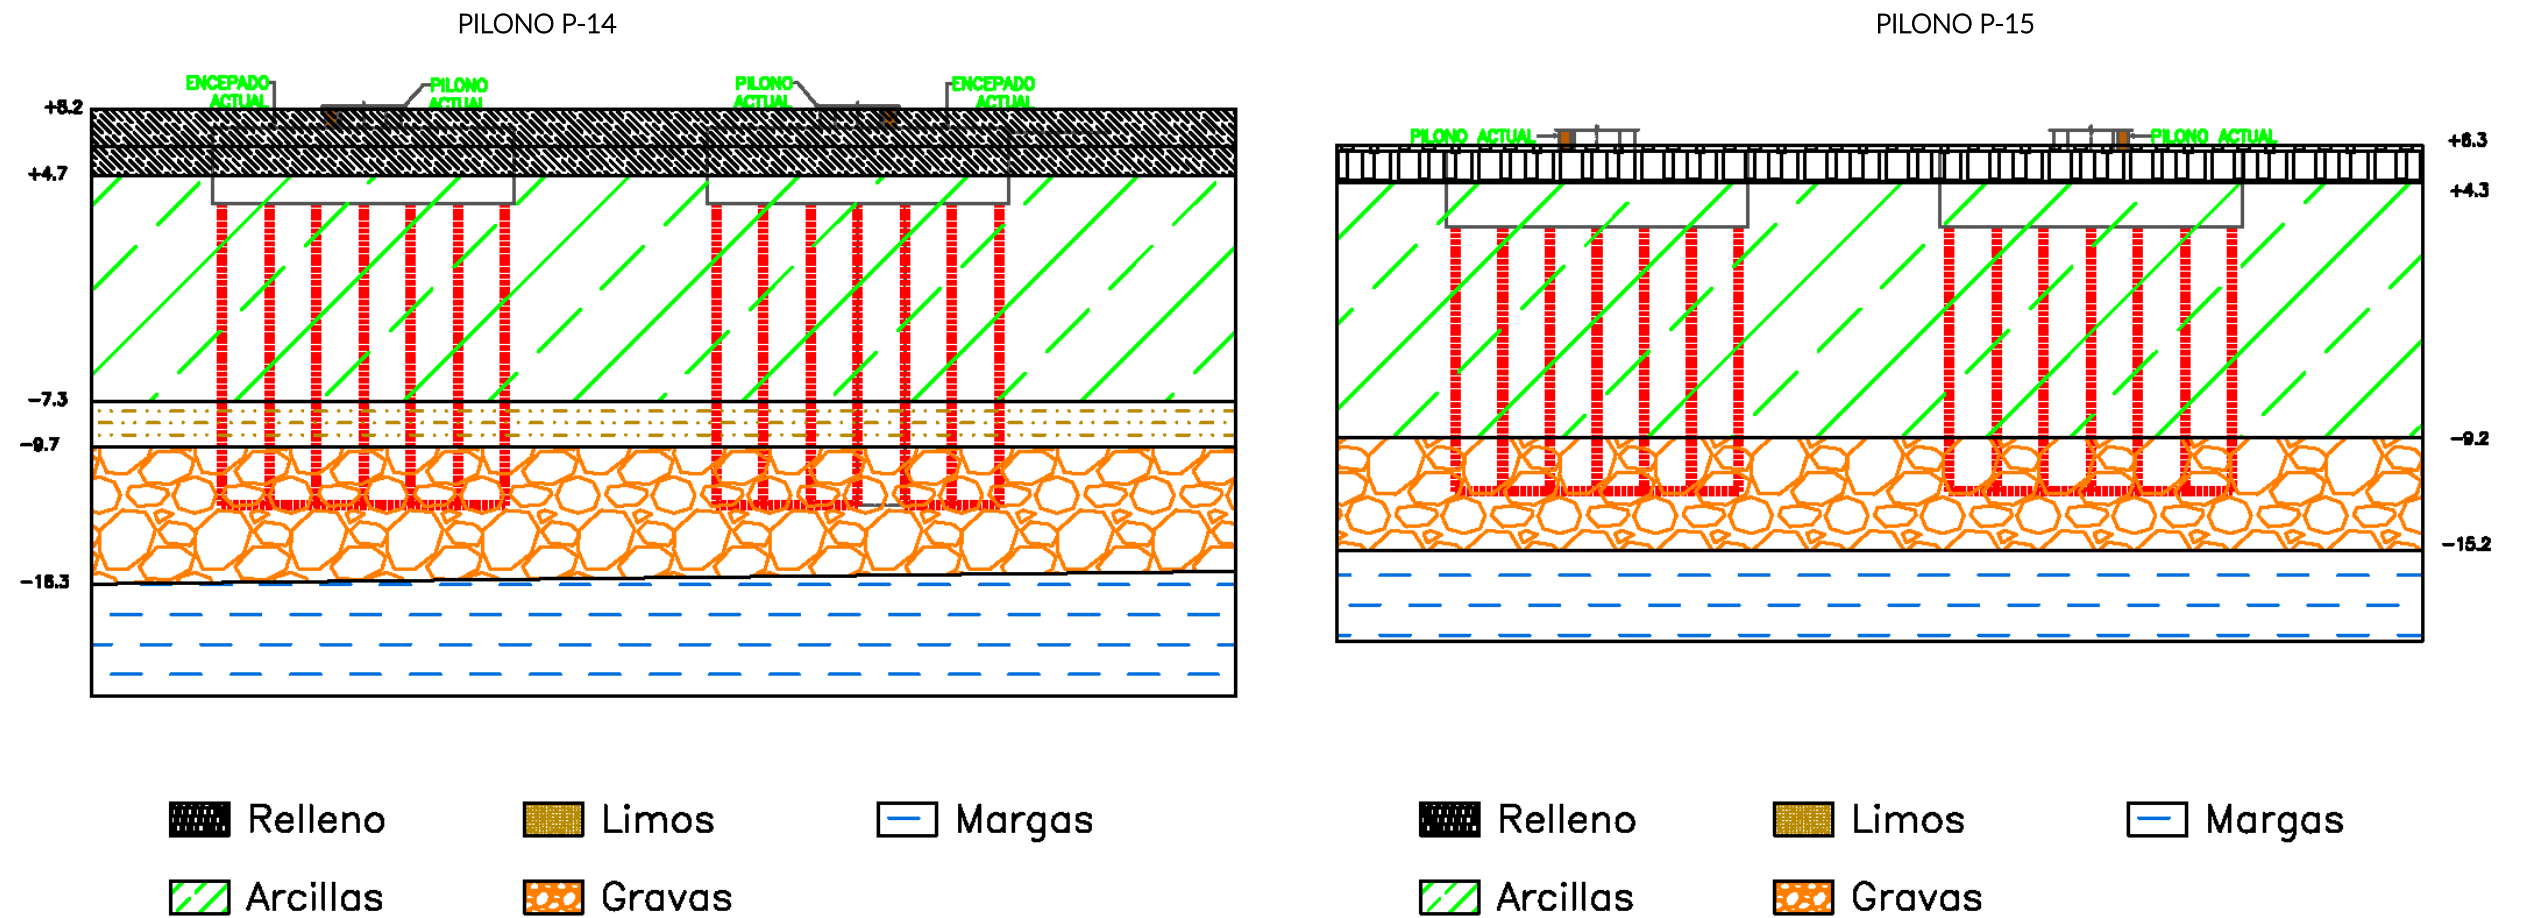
Esquema de la cimentación de las pilas P-14 y P-15
